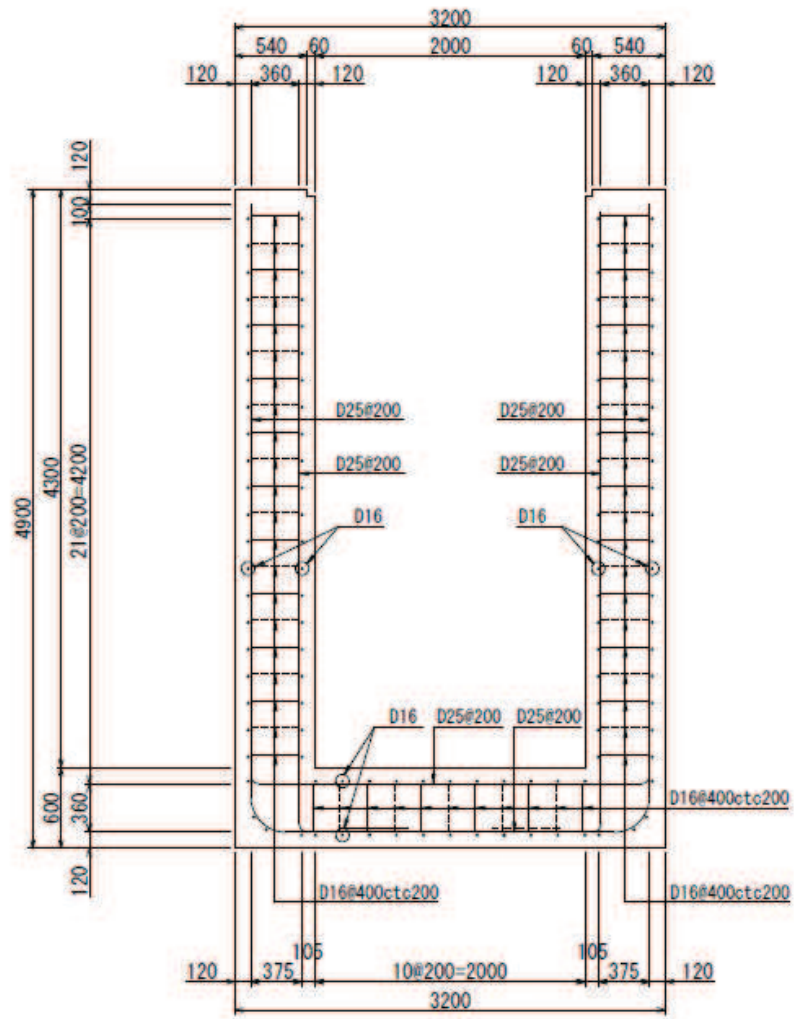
集水ピットの概略配筋図 (単位 : mm)
